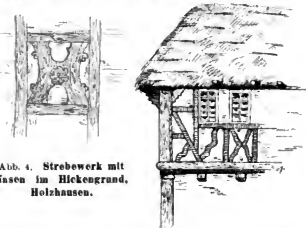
Strebewerk mit Nasen im Hickingrund, Holzhausen.
